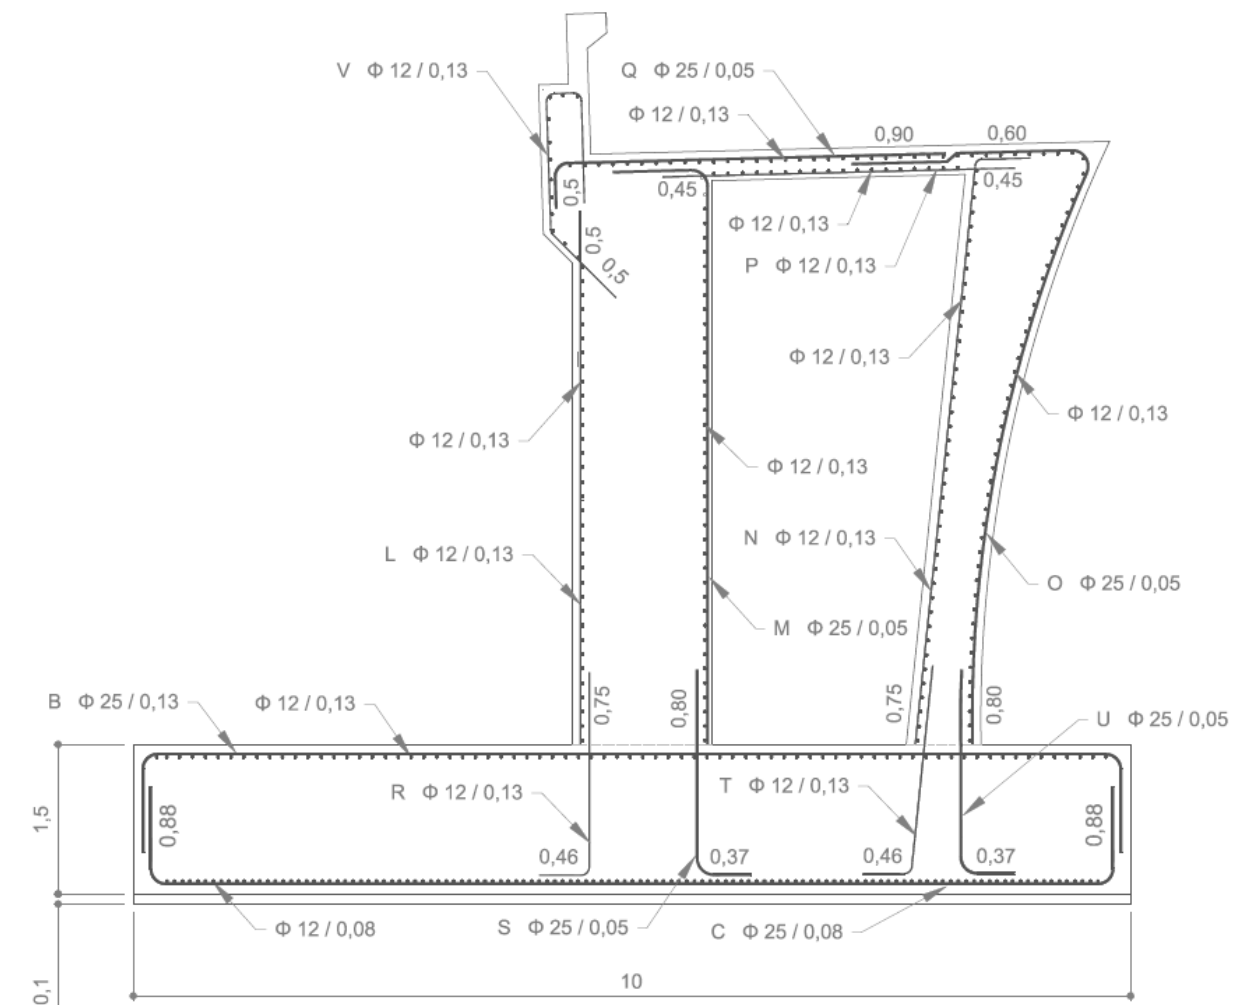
ARMADO DE LA SECCIÓN CARACTERÍSTICA DEL ESTRIBO 1.
